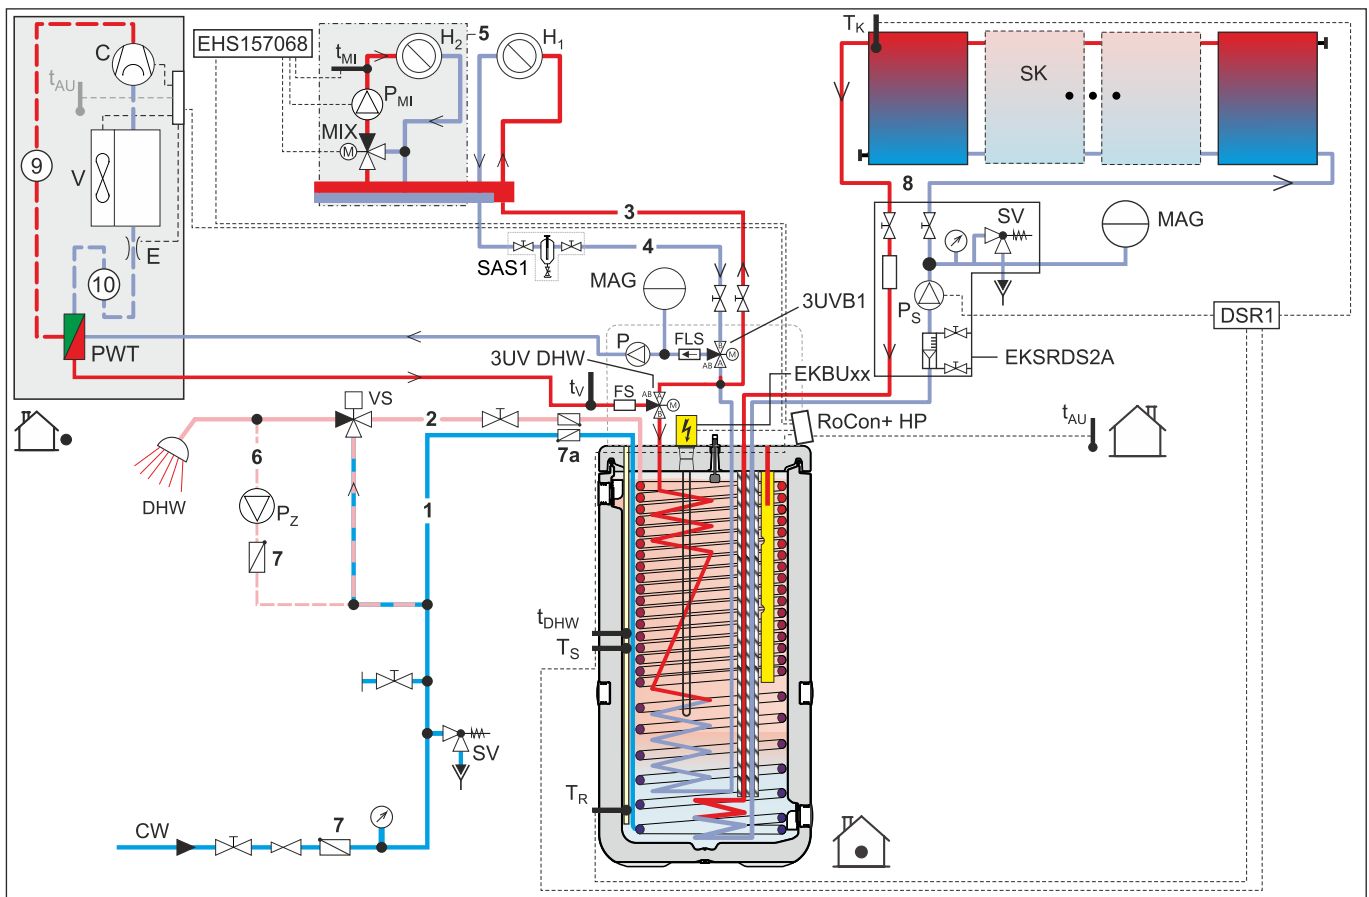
Hydraulikschema (Biv-Typen) mit Druck-Solar
